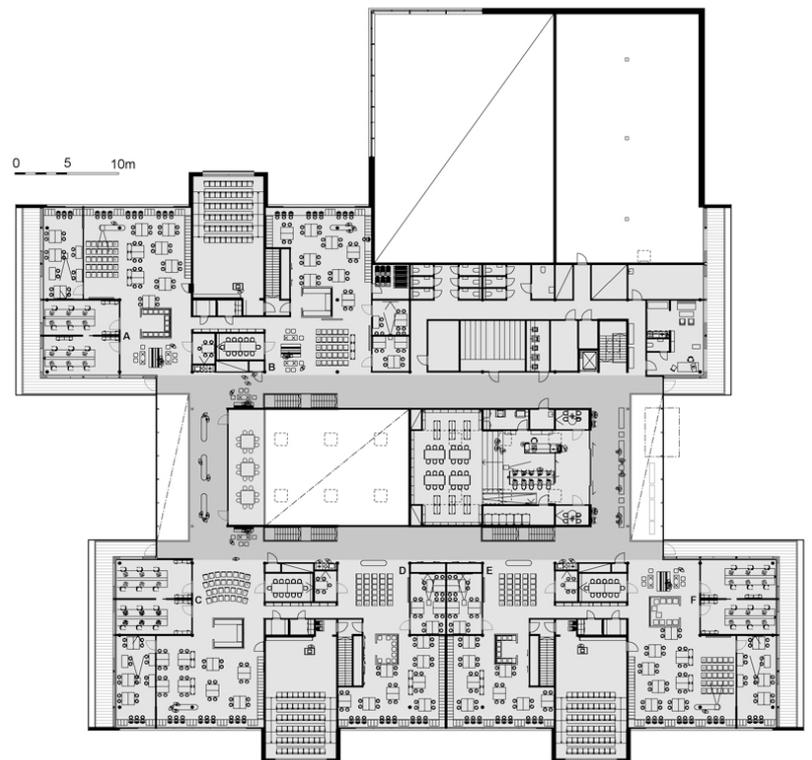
/8: Ringstabekk Skole in Baerum, Grundrisse
